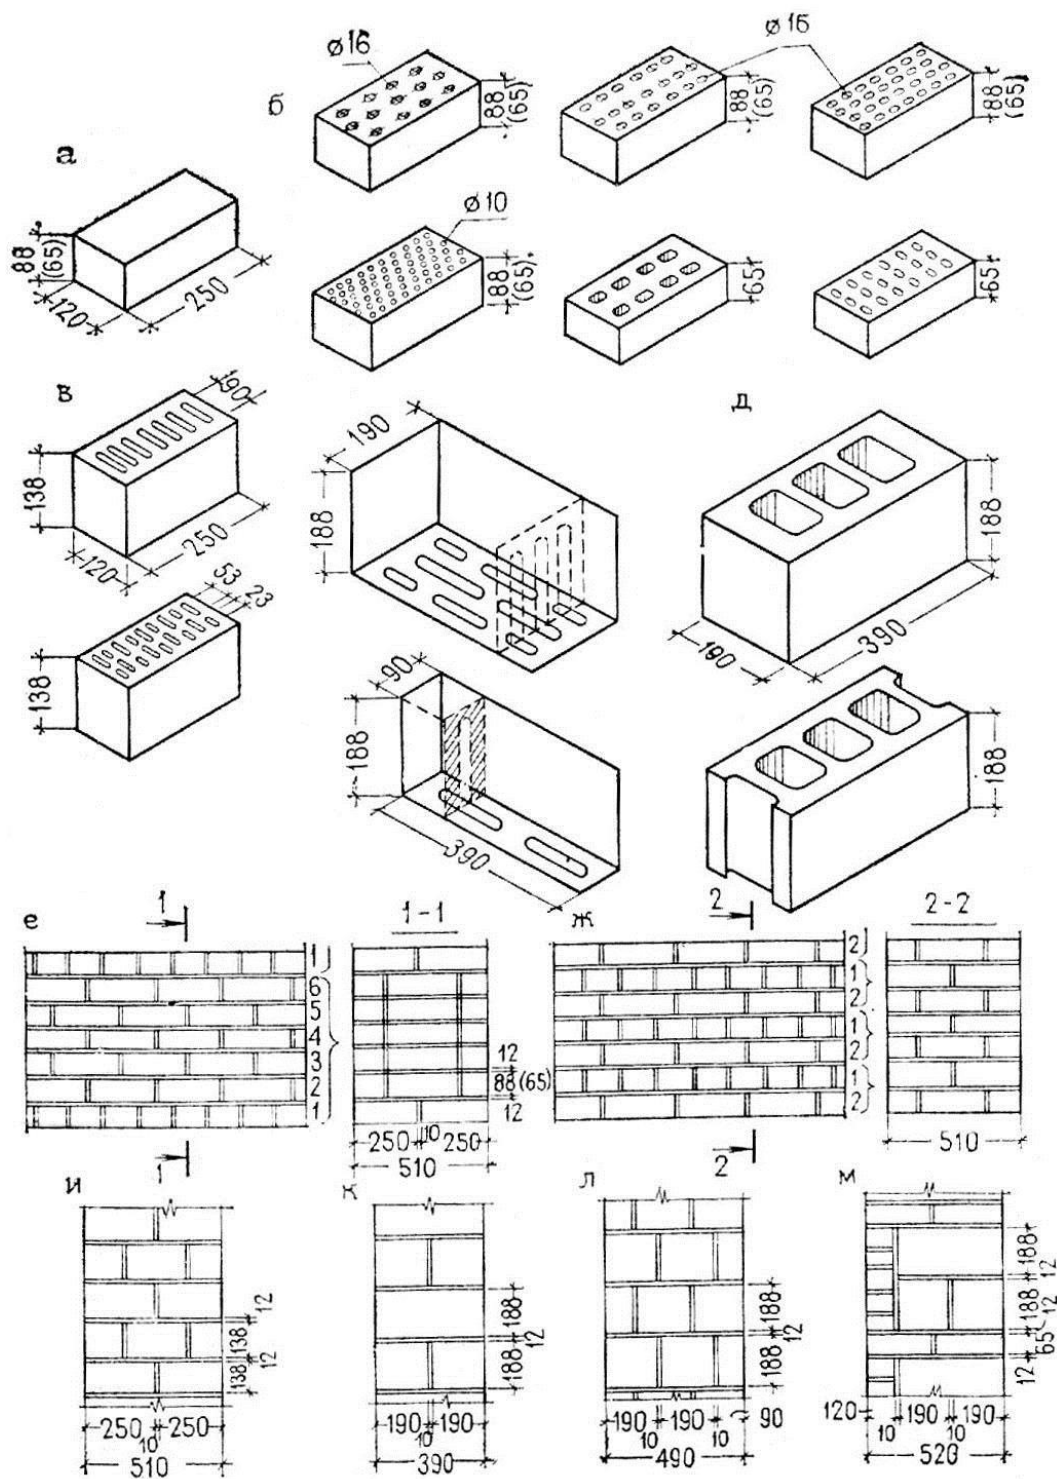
Виды керамических камней и конструкции сплошных каменных стен: а – кирпич сплошной; б – кирпич пустотелый; в – керамические камни; г – легкобетонные камни со щелевыми пустотами (целый и половинный); д – то же, трехпустотный; е – кирпичная кладка шестирядная; ж – то же, двухрядная; и – кладка из керамических камней; к, л – кладка из бетонных и природных камней; м – кладка из камней ячеистого бетона с облицовкой кирпичом.
